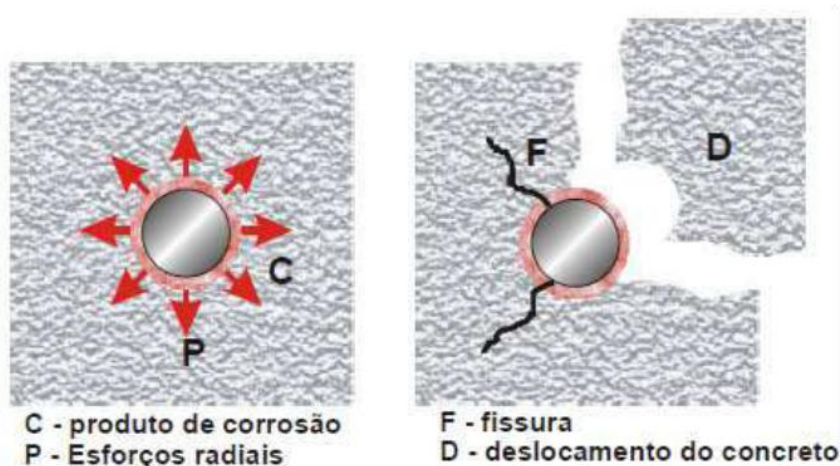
Esforços radicais produzidos que levam a fissuração e deslocamento do concreto devido à corrosão das armaduras
